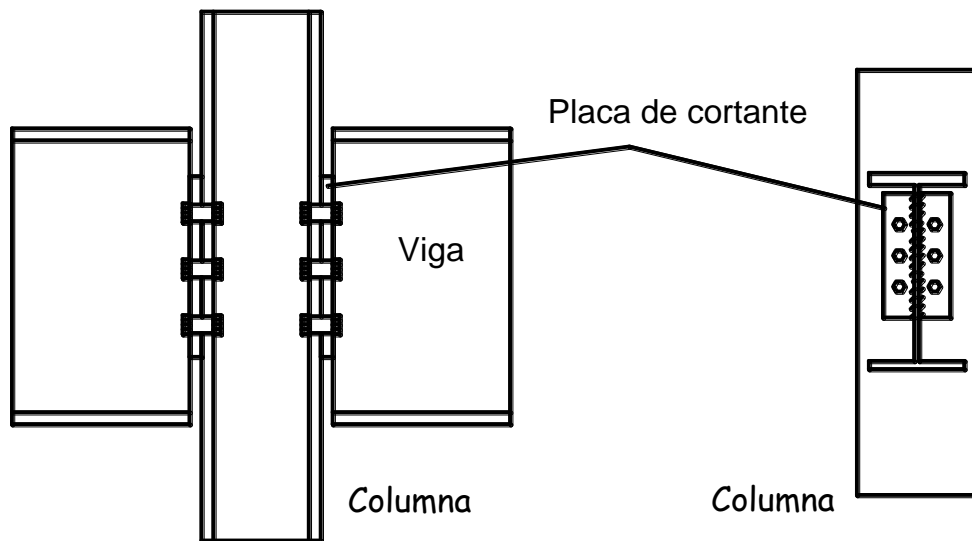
Placa cortante de extremo entre viga y columna.
